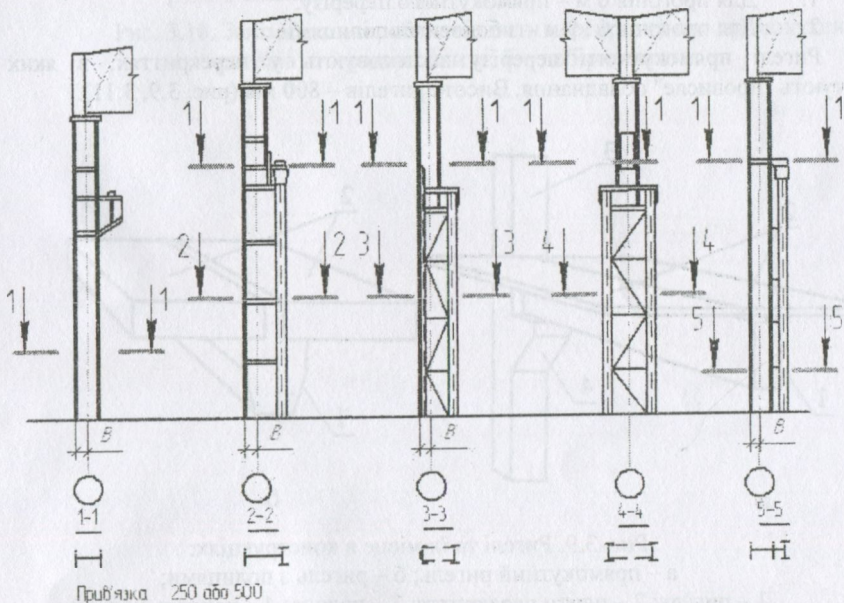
Колони каркаса одноповерхових промислових будівель
